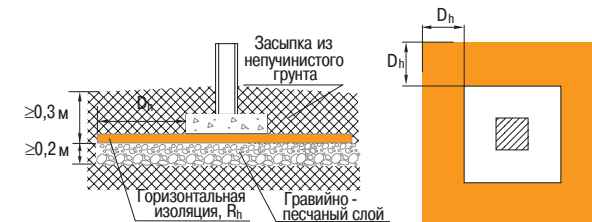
Схема поперечного разреза и план расположения изоляционных плит «Пеноплэкс®» для отдельно стоящих колонн
